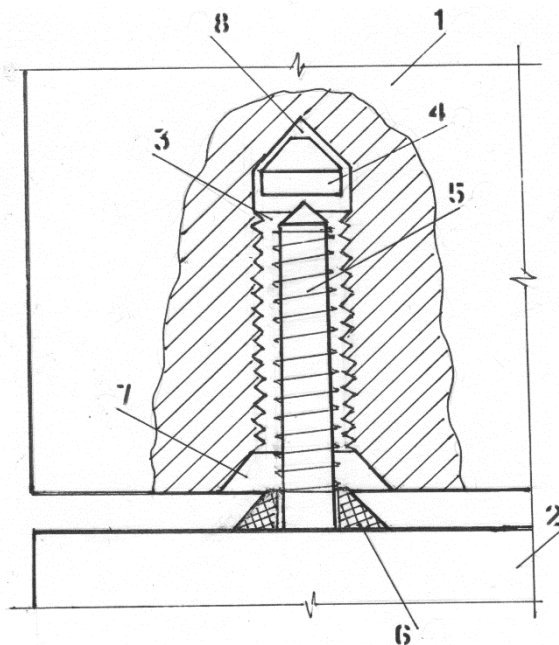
Унифицированный клеевой монтажный стык для железобетонных конструкций:
